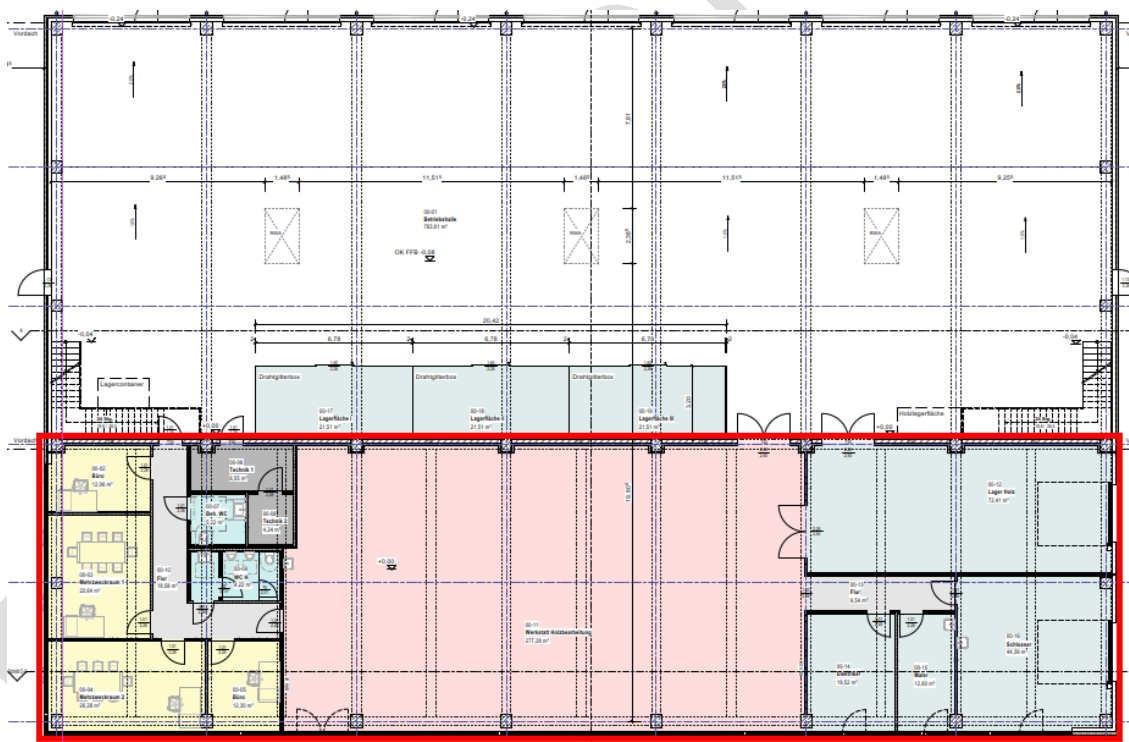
thermische Hülle der Bestandsgebäude nach GEG (rot markierte Flächen)- EG Plan
